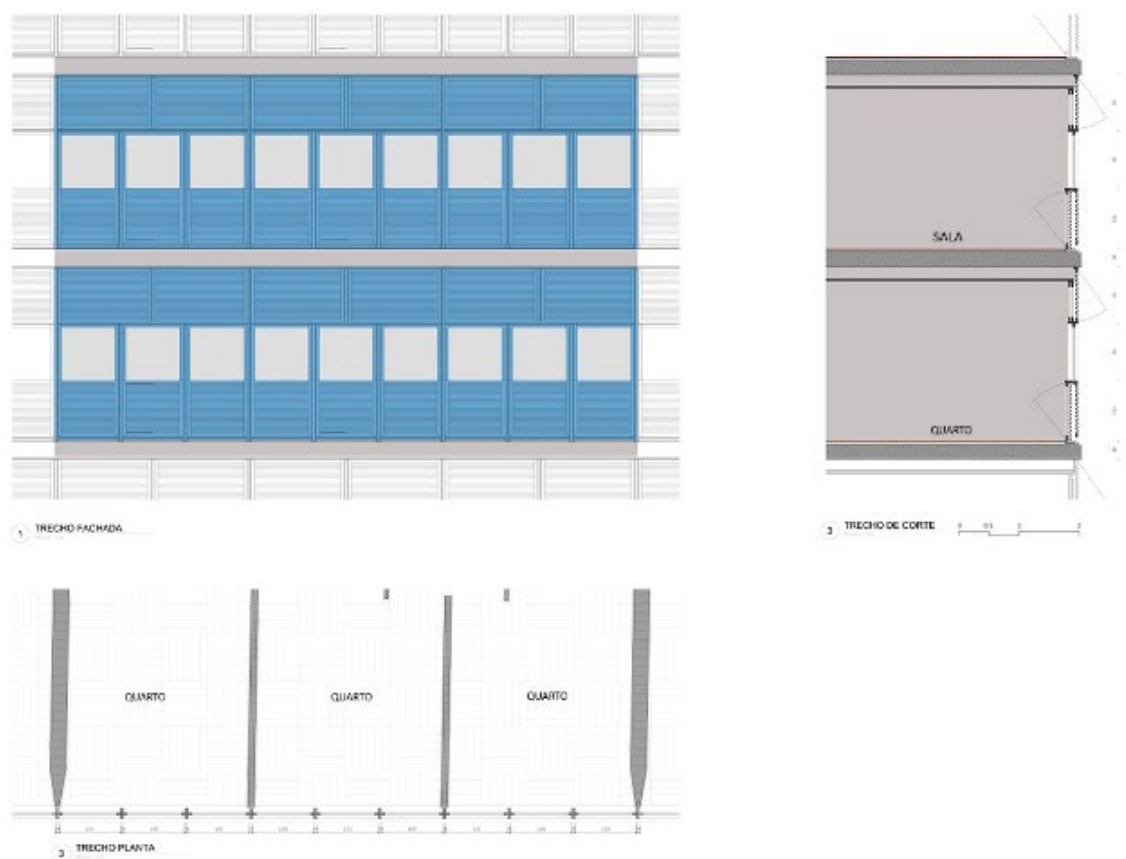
Edifício Angel Ramirez, trecho de planta, trecho de corte e trecho de fachada de um apartamento. Desenhos de Júlia Lopez, 2021.
